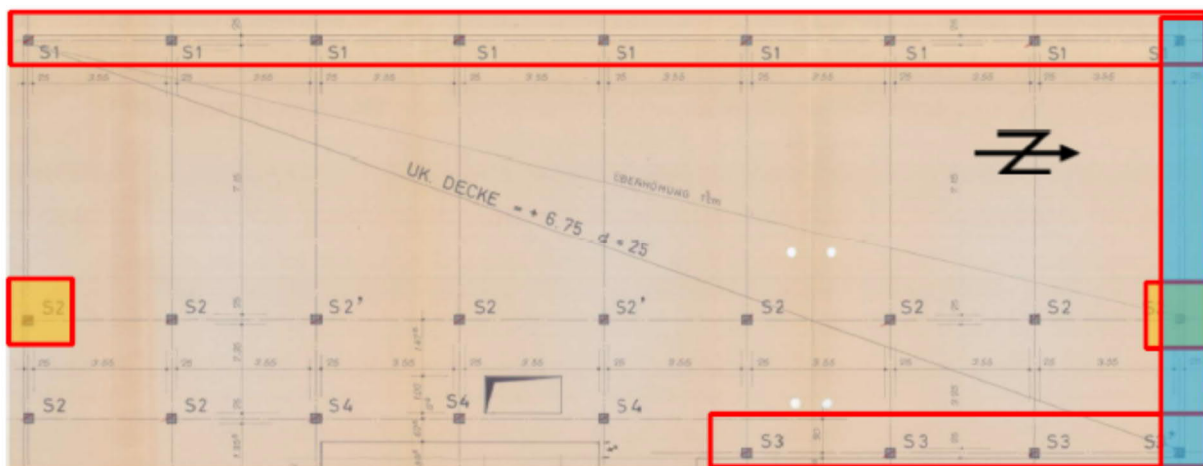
Plan horizontal de l'étage supérieur. La résistance au poinçonnement des piliers marqués n'est pas garantie.
